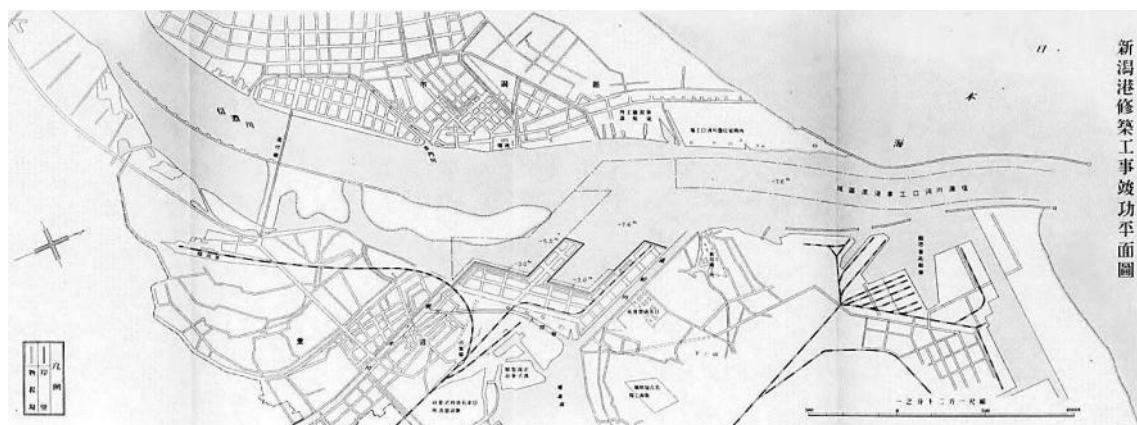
新潟港修築工事竣工平面図 [241] 河口東側が新潟臨港株式会社埠頭
